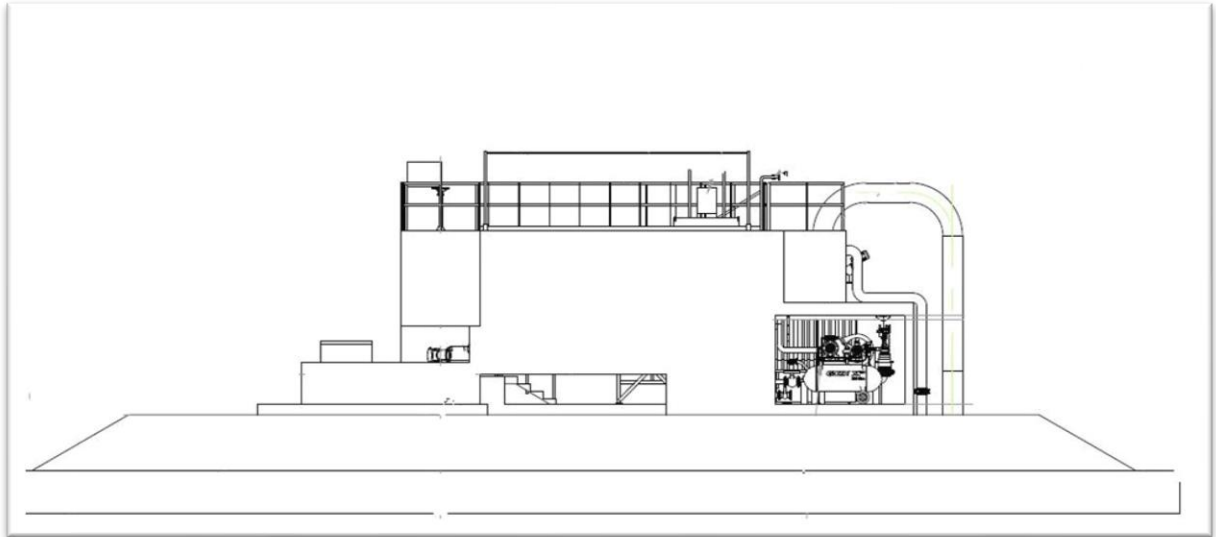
Vista en corte longitudinal del sector desarenador y desengrasador.
